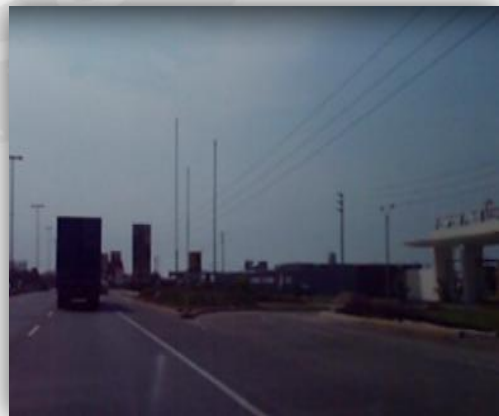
Vista de Acceso 6. La berma es utilizada como carril de desaceleración.
